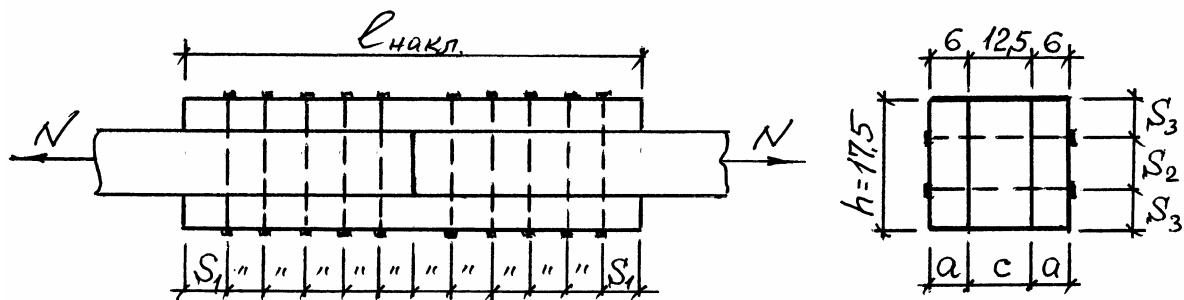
До розрахунку розтягнутого стика на циліндричних нагелях
